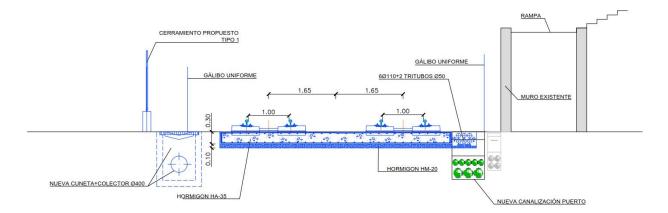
SISTEMA DE DRENAJE CUNETA+COLECTOR EN MARGEN IZQUIERDO
